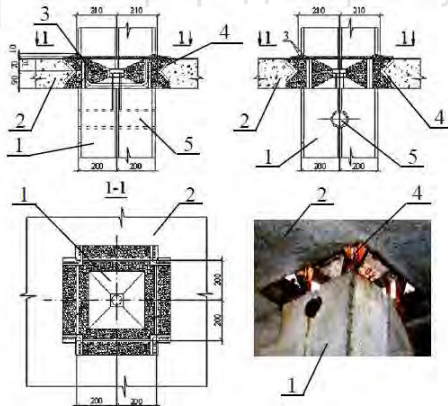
Схеми з'єднання надколонної плити з колоною: 1 – колона; 2 – плита (вид знизу); 3 – бетон; 4 – сталевая обойма; 5 – монтажний отвір
